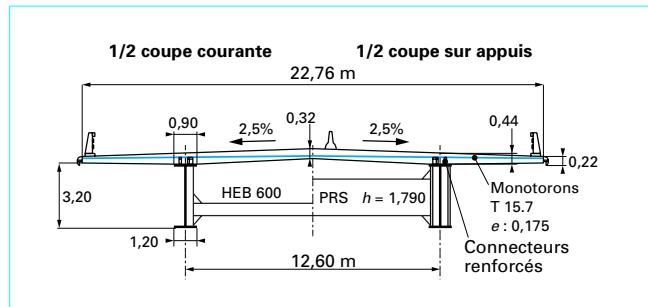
Bipoutre avec dalle précontrainte transversalement
